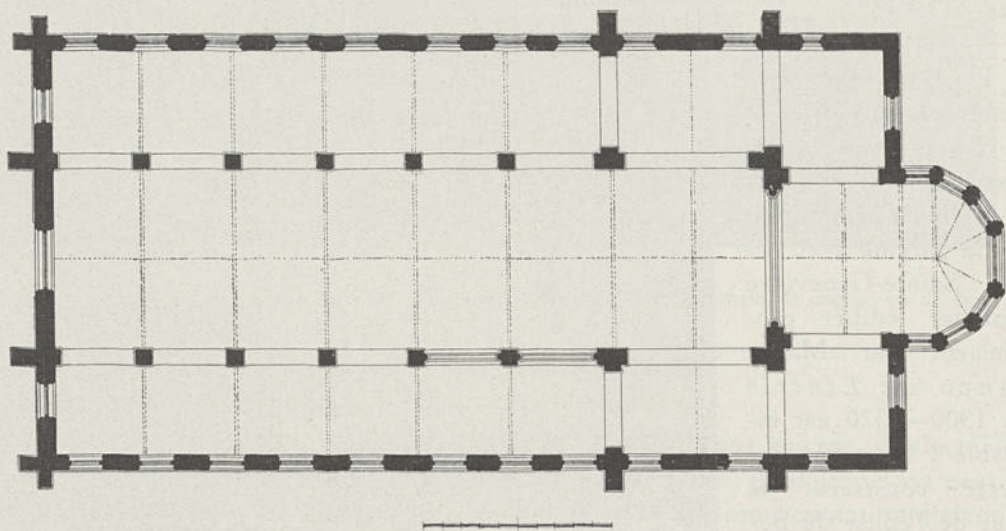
Tirlemont, Eglise du Béguinage, plan terrier
